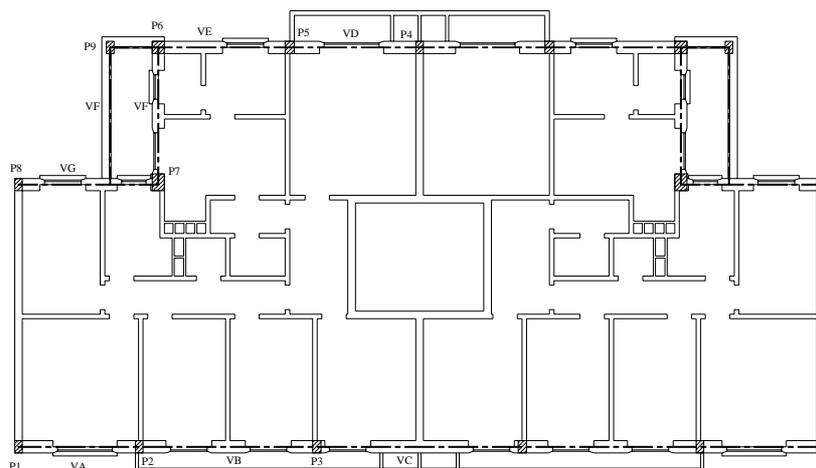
Planta de piso de um edifício de “placa”, com 4 pisos elevados e com pilares e vigas em betão armado nas fachadas principal e de tardoz.
